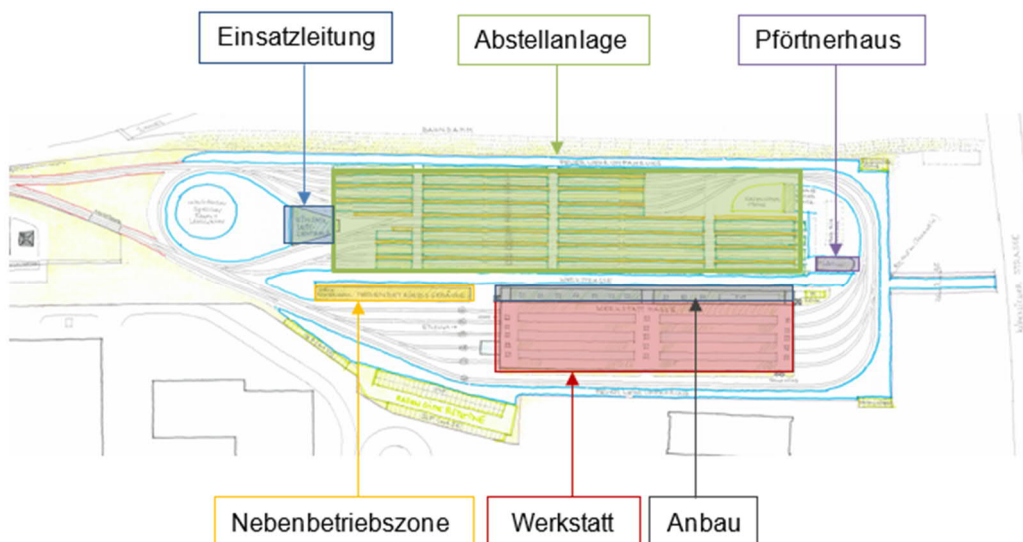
Nutzung Betriebshof (Ausschnitt Lageplan)
